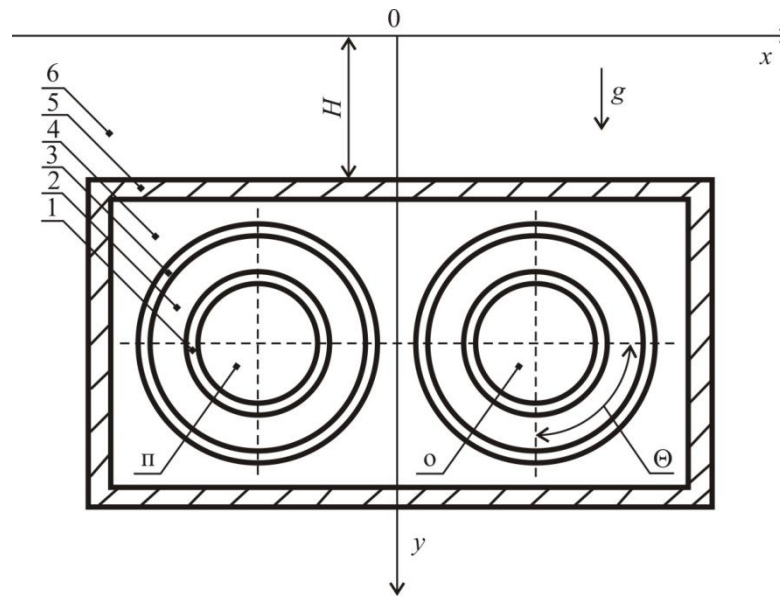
Схема области решения: 1 – труба; 2 – тепловая изоляция; 3 – покровный слой; 4 – полость канала; 5 – стенка канала; 6 – грунт, п – подающий трубопровод; о – обратный трубопровод
